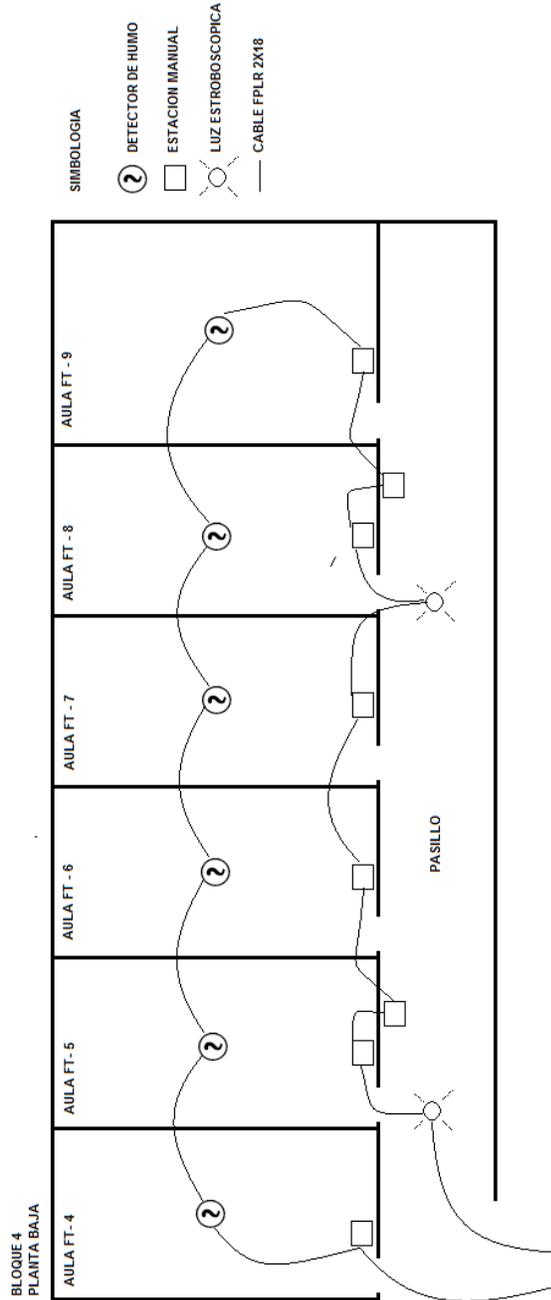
Diseño de conexión de la planta baja del bloque 4, área de aulas
